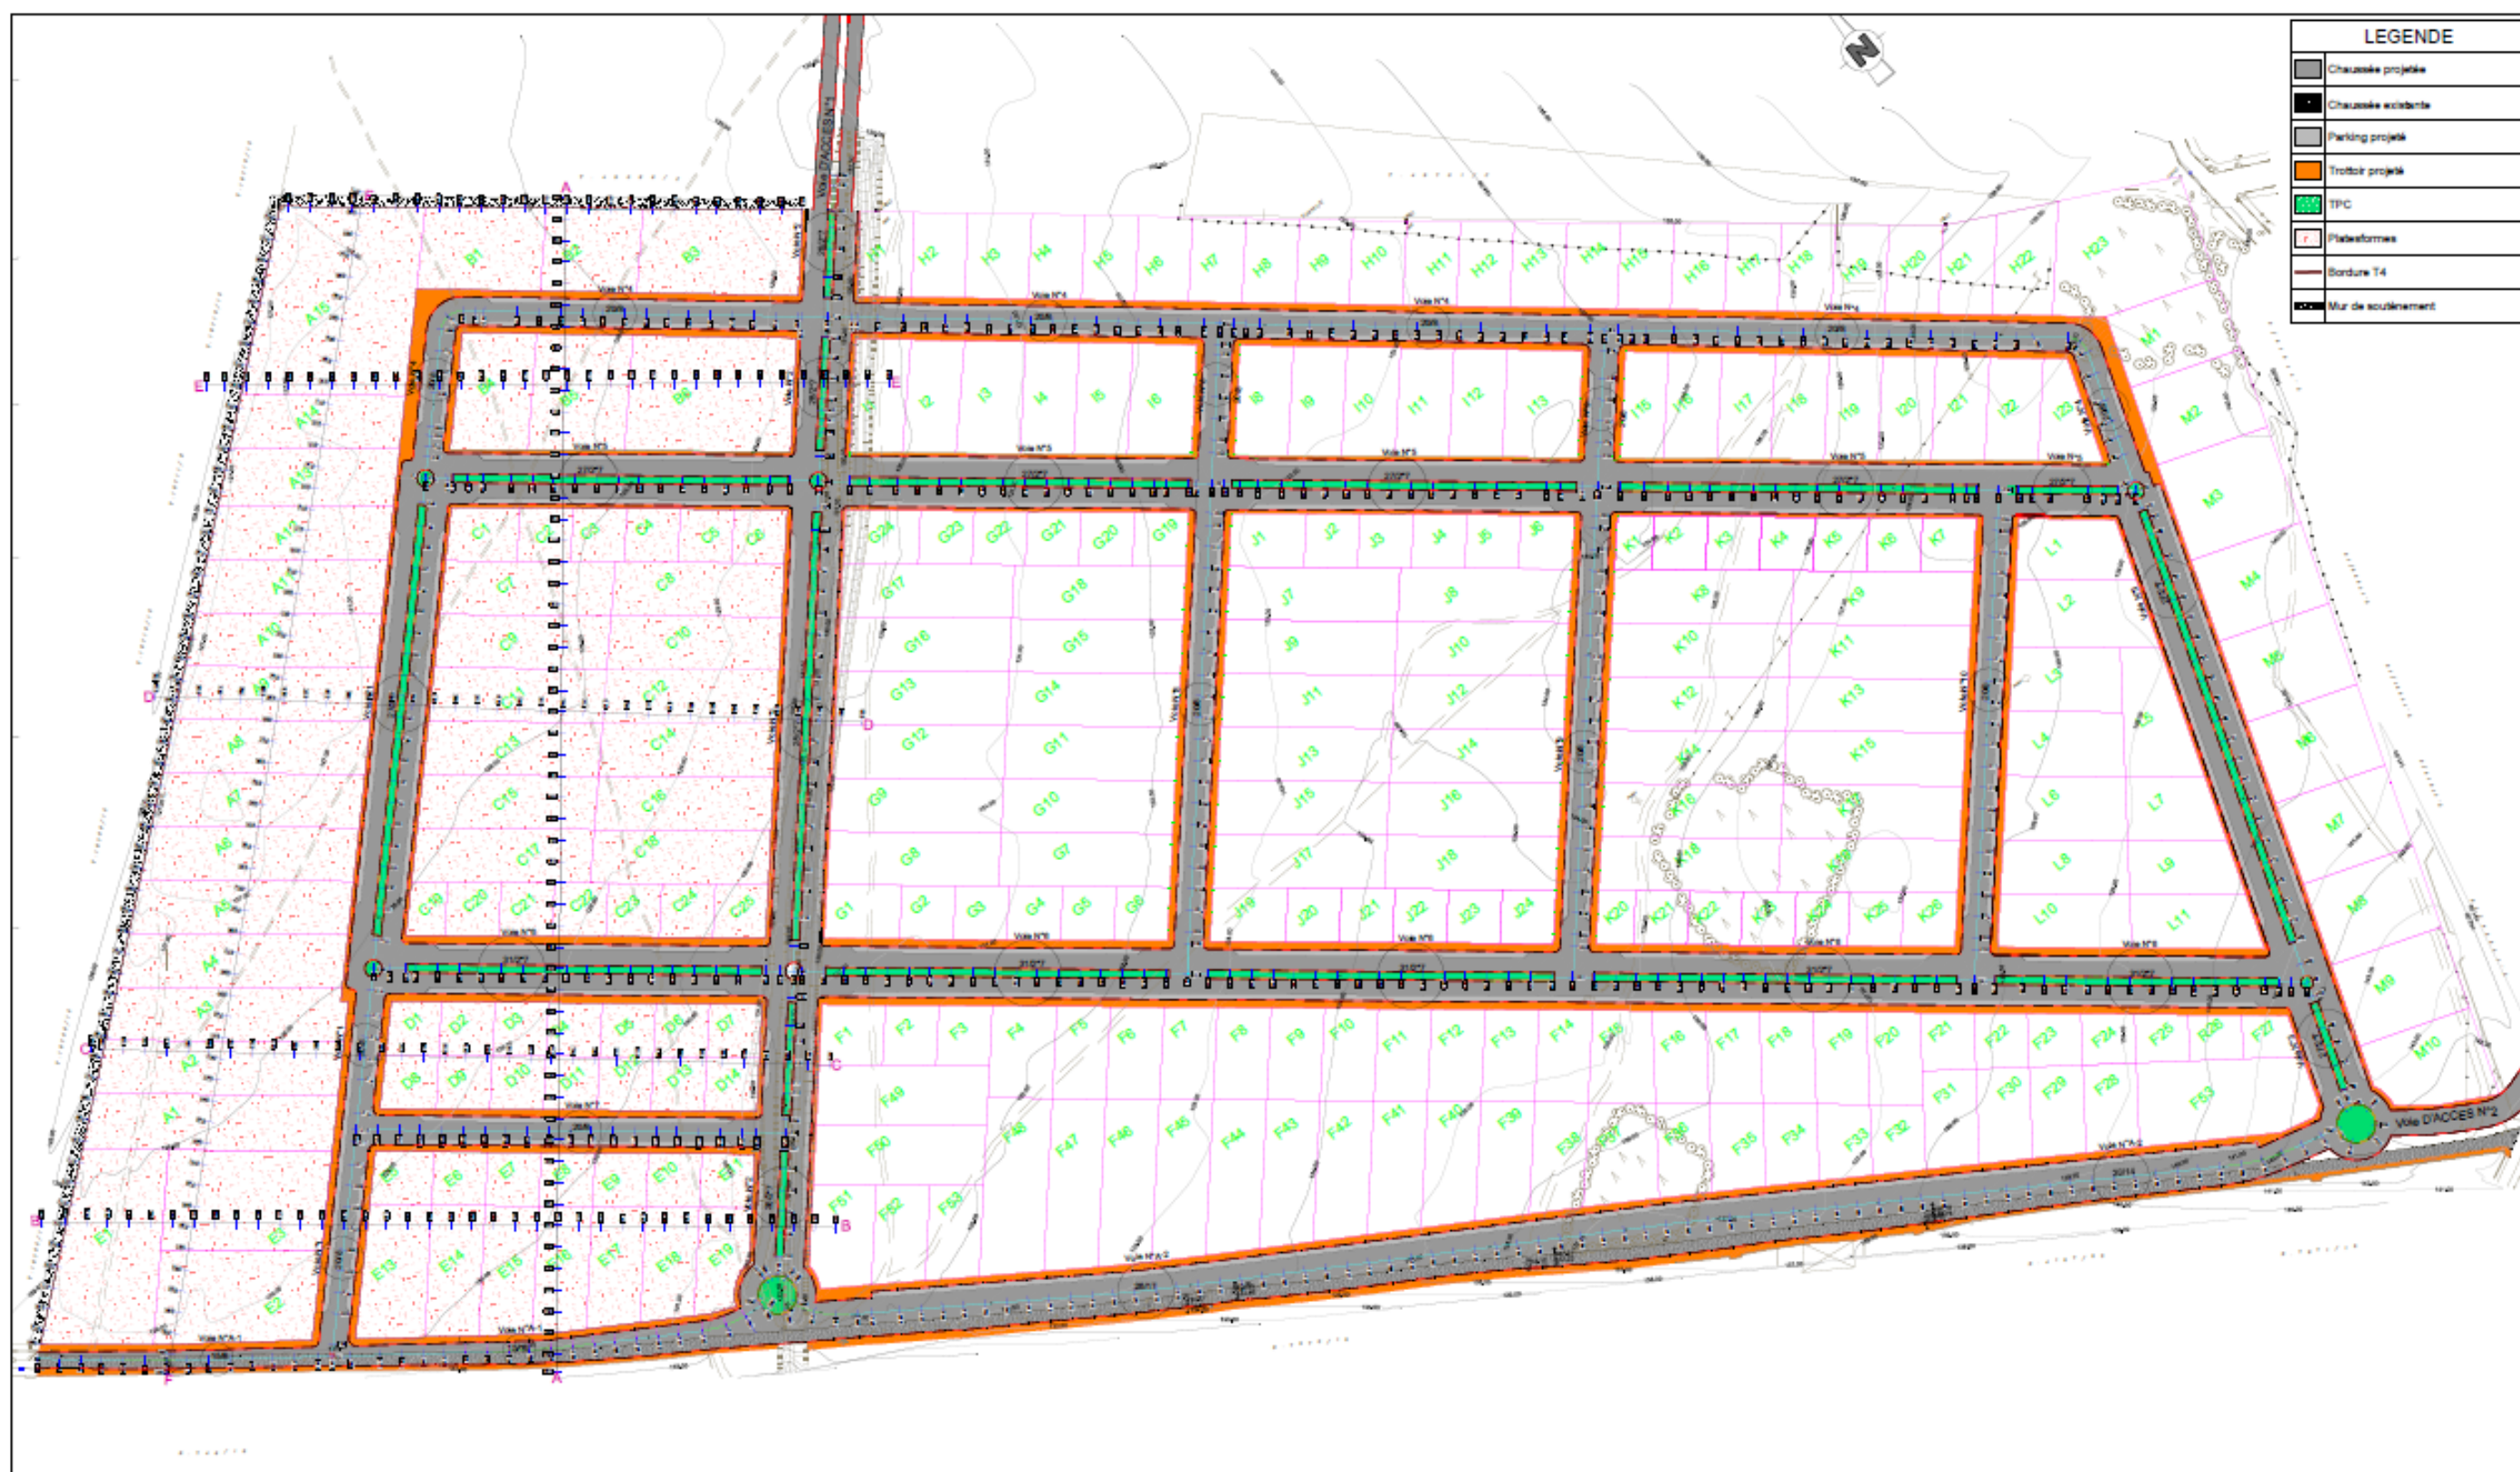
Tracé en plan du réseau de voirie interne – Extension de la ZI Had Soualem.
